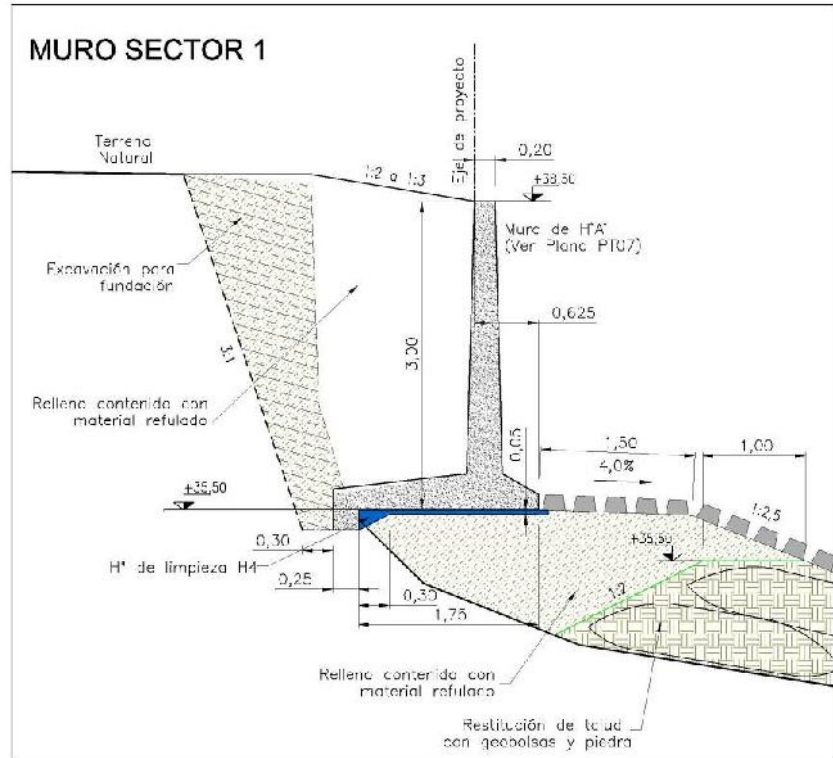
Perfil tipo de la defensa en Sector 1, zona pedrera.
